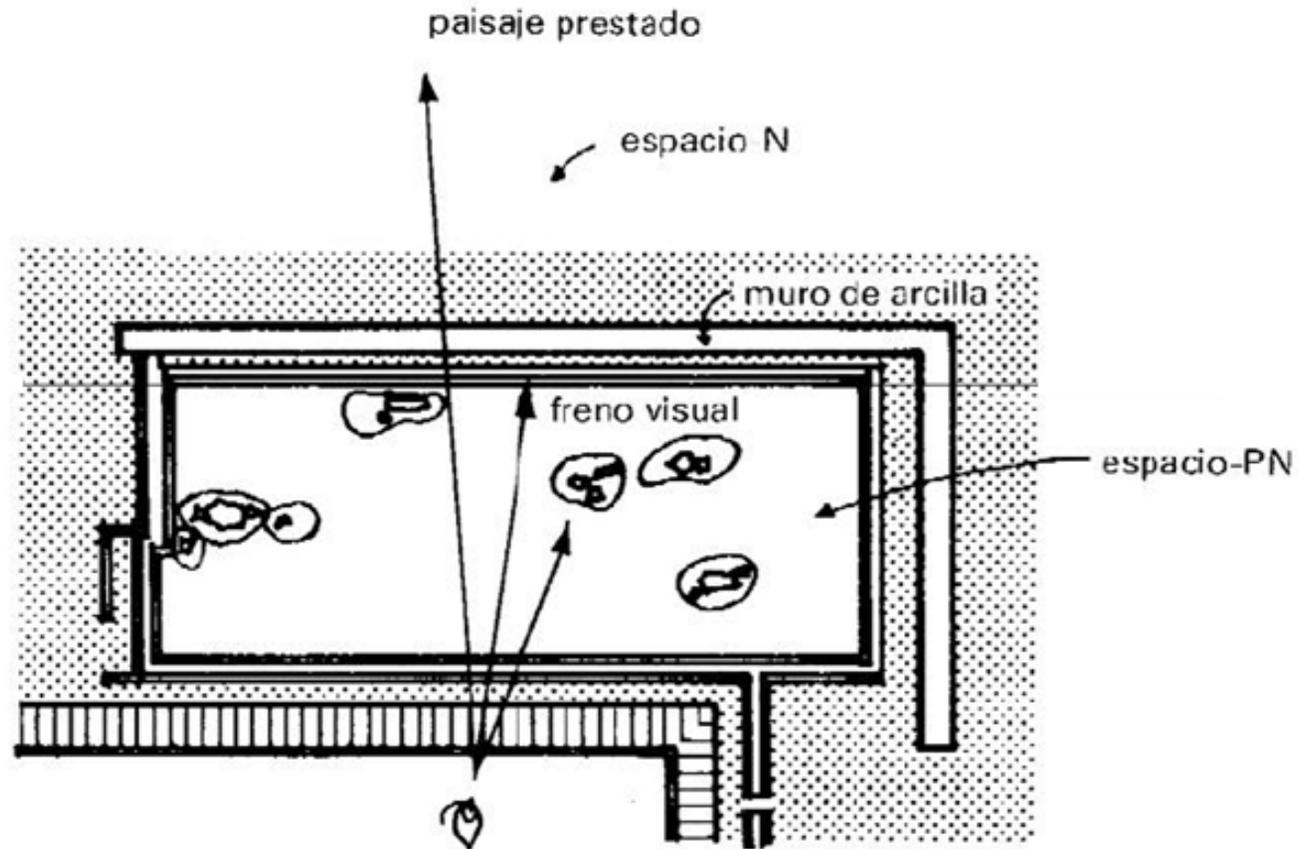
Planta jardim do Templo Ryoanji, Kyoto
